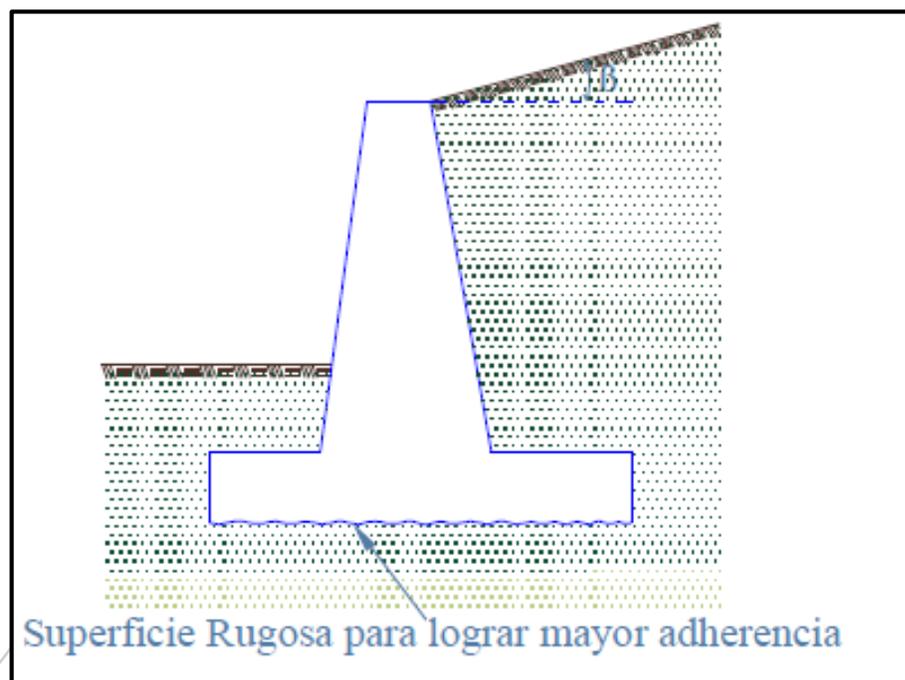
Interacción entre el muro y el suelo de cimentación. Gallegos., C.G. (2006).
